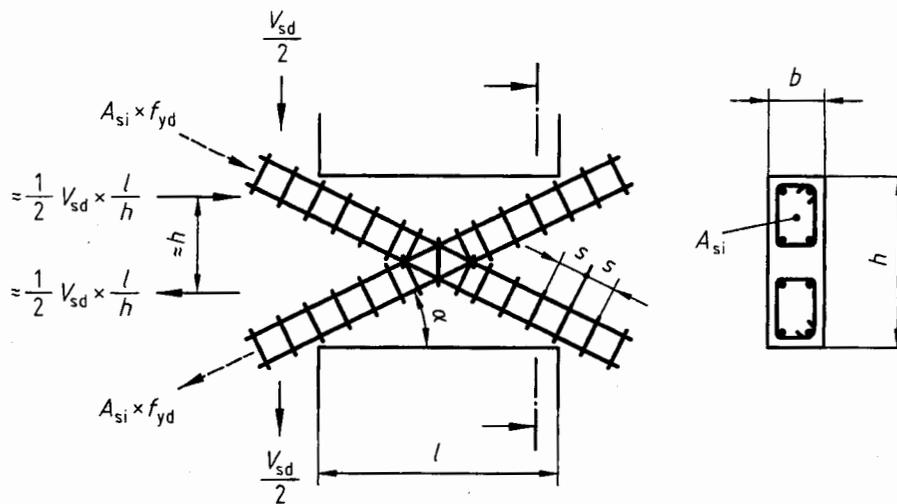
Koppelbauteil mit Diagonalbewehrung
